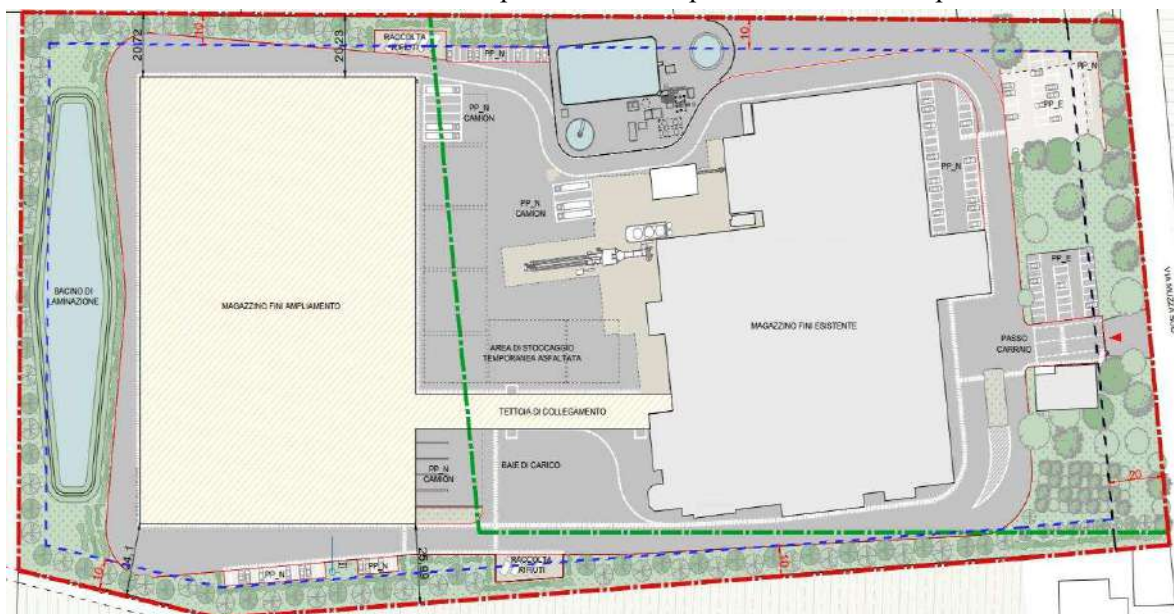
Planimetria generale futuro Stabilimento GRUPPO FINI S.p.A. Via Confine nr. 1583 Ravarino (MO)
